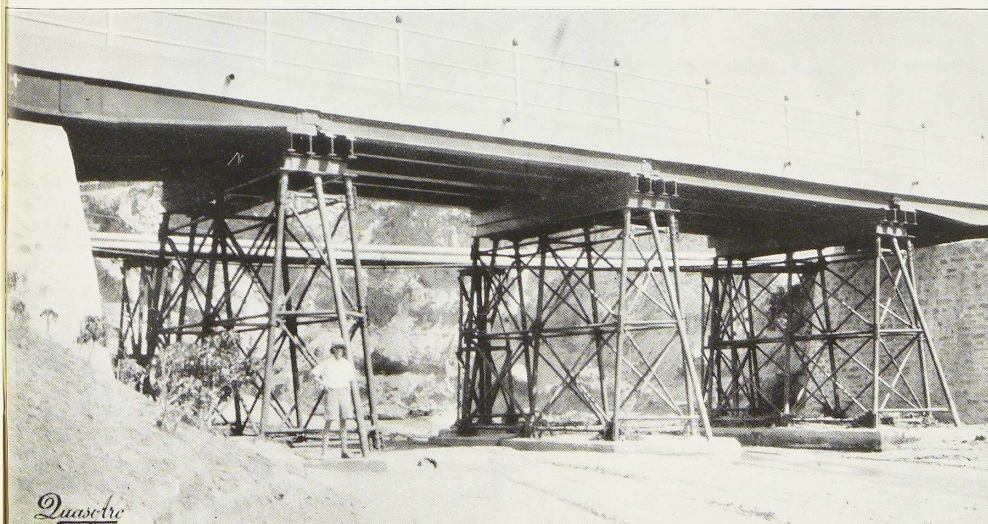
Pont route de Khodaung à Burma, Indes. Les piles sont formées de tubes métalliques assemblés par soudure. (D'après la revue *Electric Welding*.)
